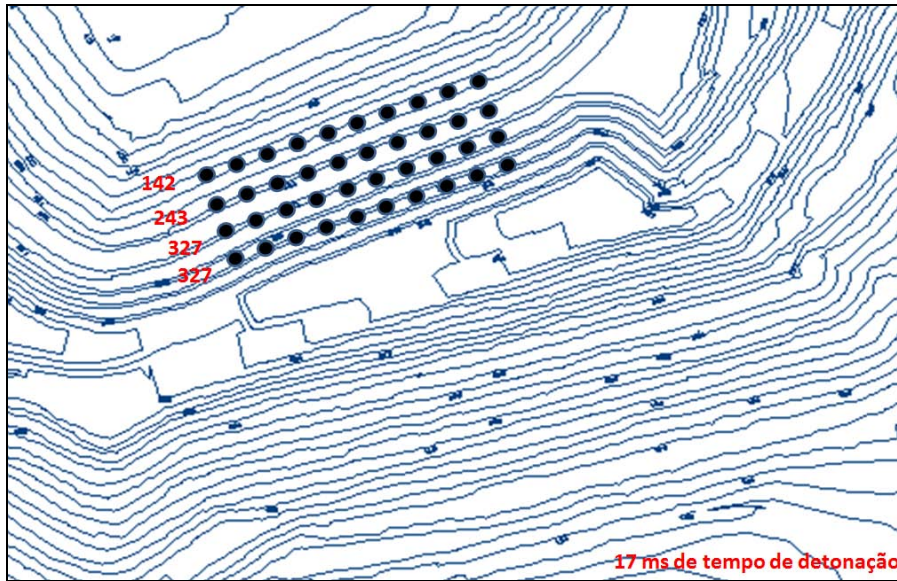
Plano da saída da detonação em mili segundos por fileira de perfuração.
